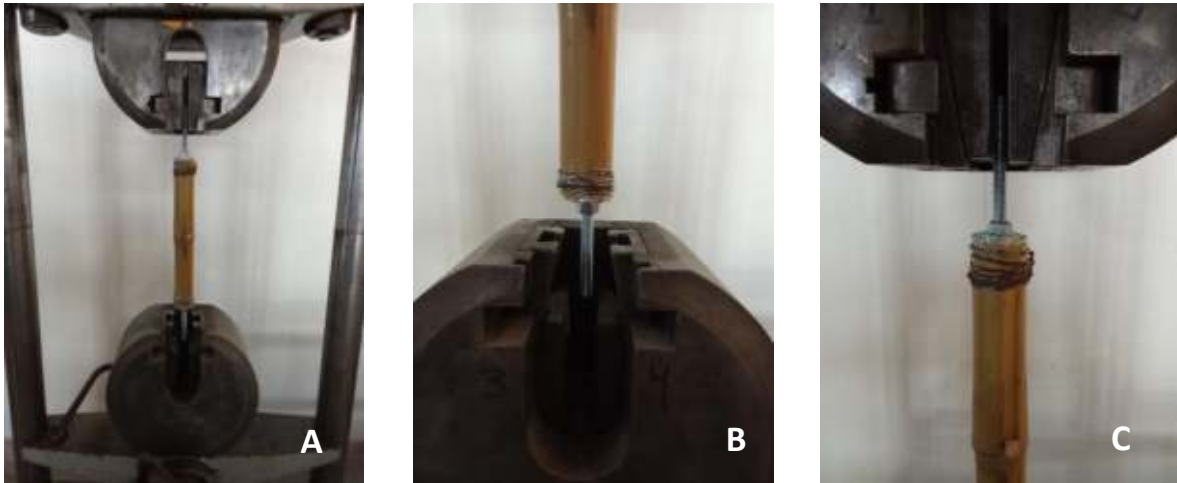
Dispositivo a tracción del dispositivo 3. a) Pieza sin deformación, b) Detalle sin deformación inferior, c) Detalle sin deformación superior.
